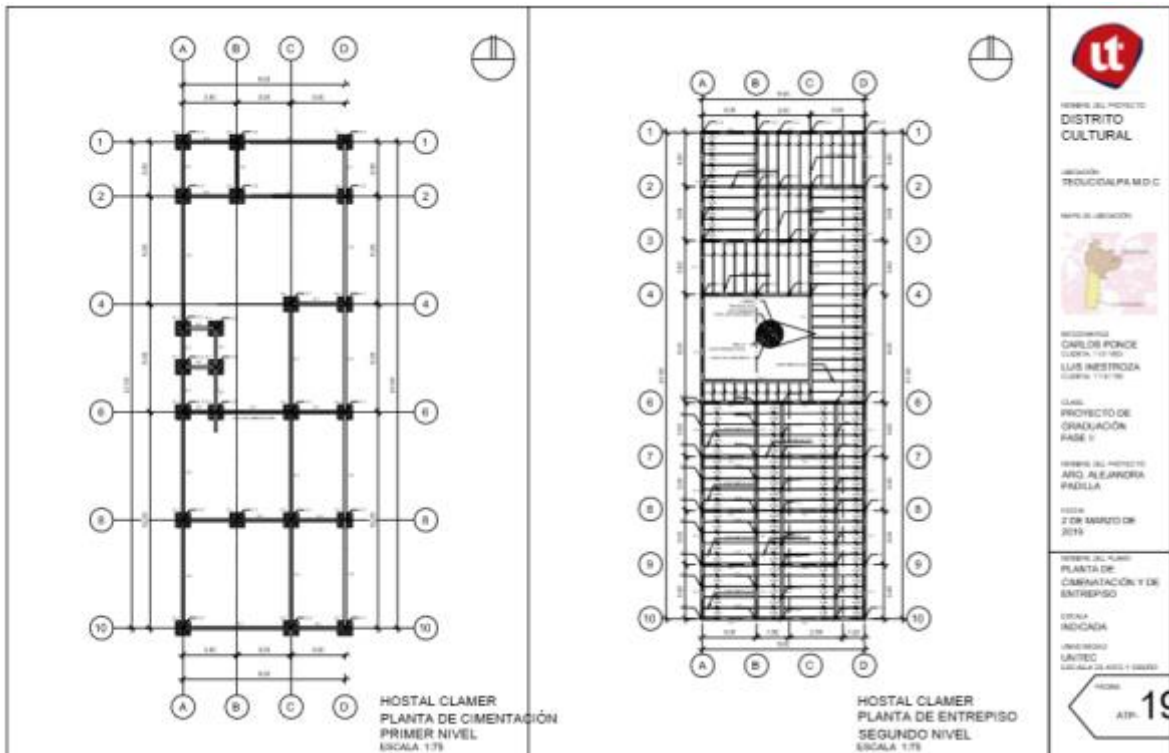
Plantas de Cimentación y Entrepiso Hostal Clámer
